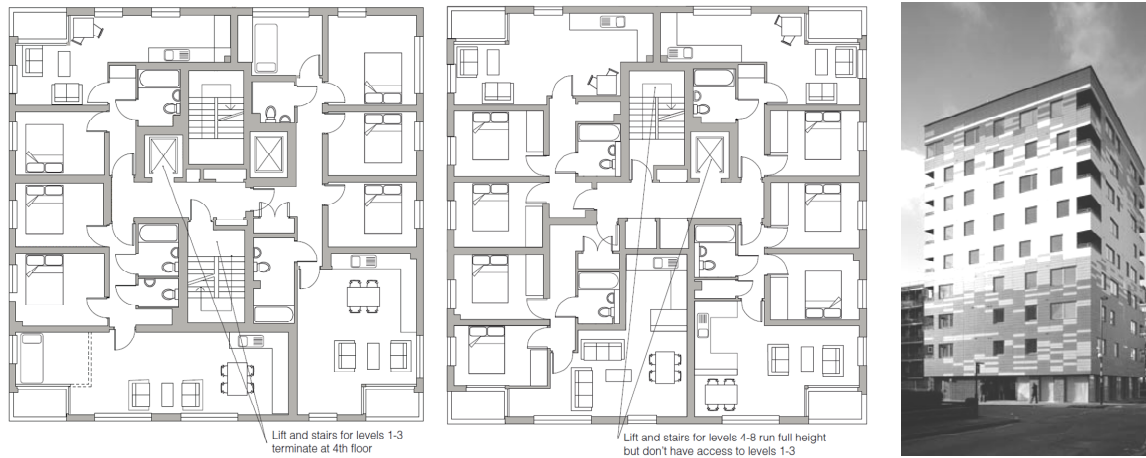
De izquierda a derecha, plantas 1^a-3^a, plantas 4^a-8^a, e imagen exterior. TRADA technology, www.trada.co.uk y Waugh Thistleton Architects.
